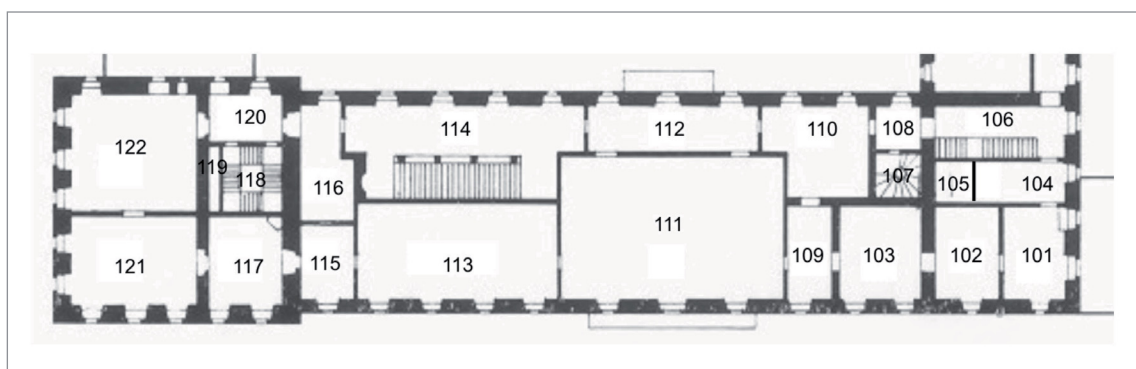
Grundriss des ersten Obergeschosses des Königsflügels mit den Kaiserappartements und Raumnumerierung 2008 (aktuelle Numerierung).
